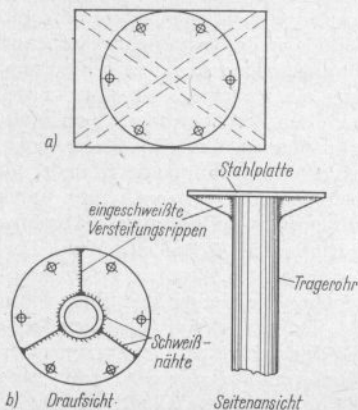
Die Mastbefestigung am Kreuzstück;
